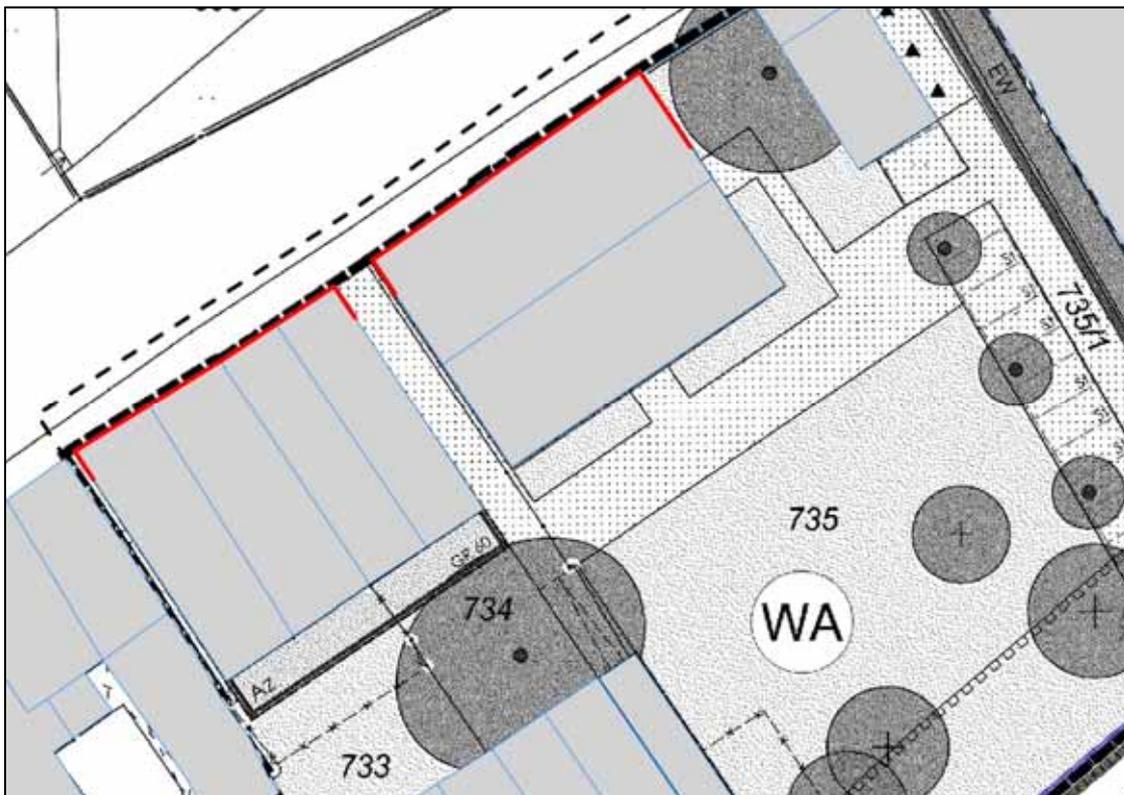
Lageplan mit Fassadenkennzeichnung (Maßstab M 1:500)
